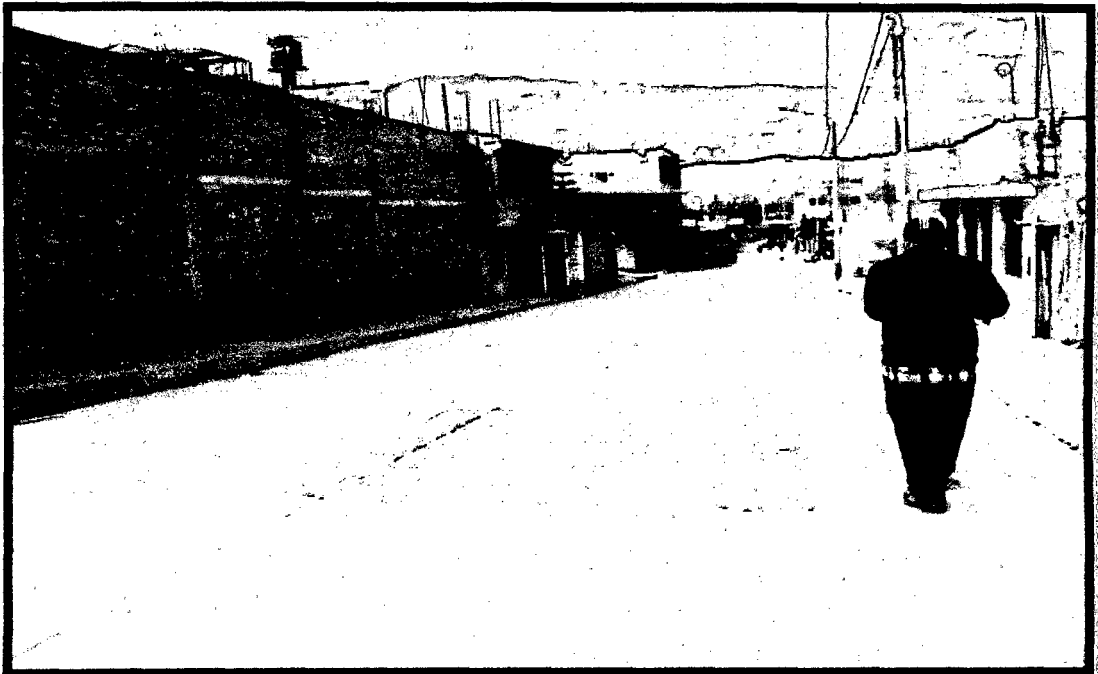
Pavimentación con bombeo para evacuación de aguas de lluvia (Jr. San Luis).
